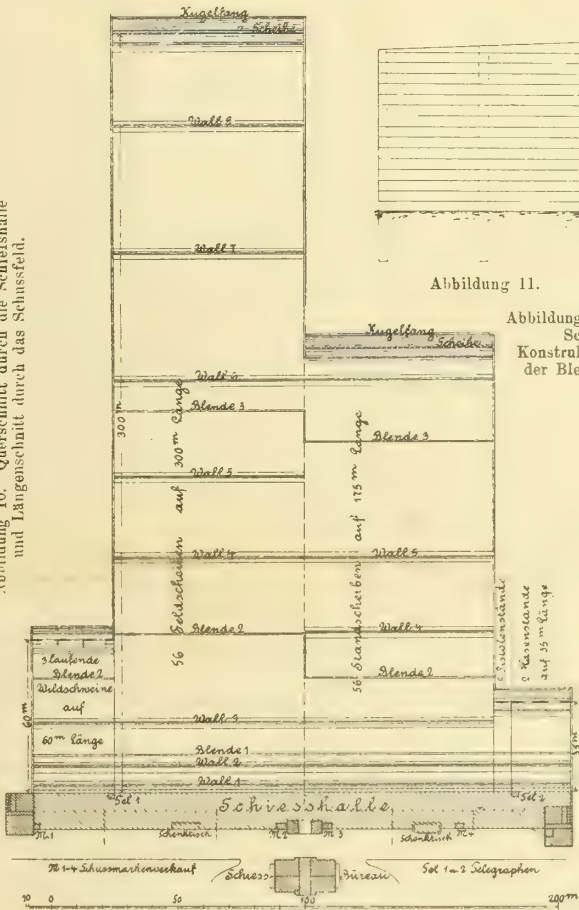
Gesamt-Grundriss der Schiefschale mit dem Schussfeld und dem Schiefs-Bureau.
